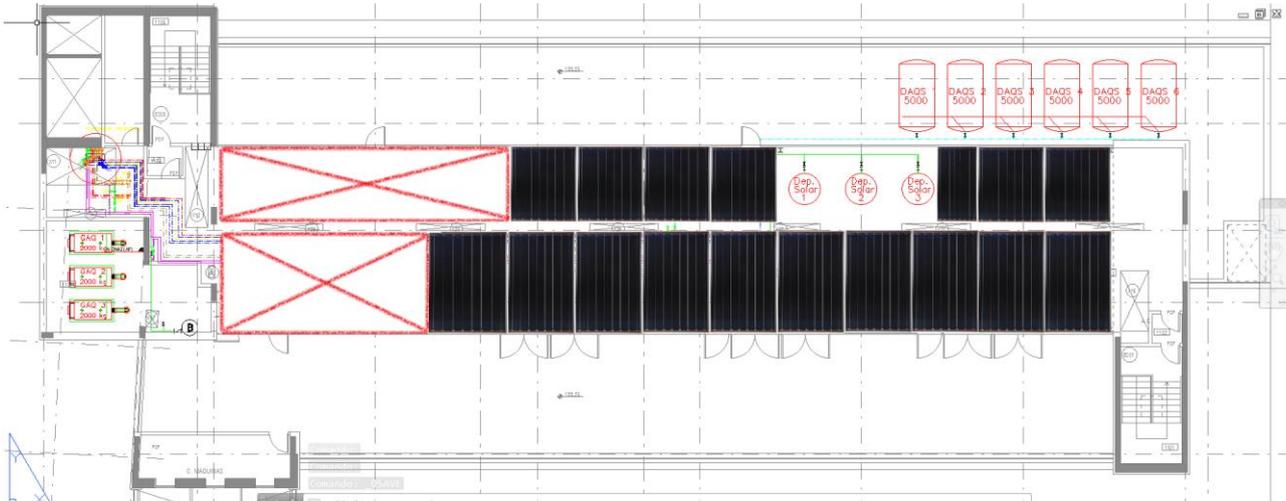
Planta do piso 11 do hotel EPIC SANA Lisboa
